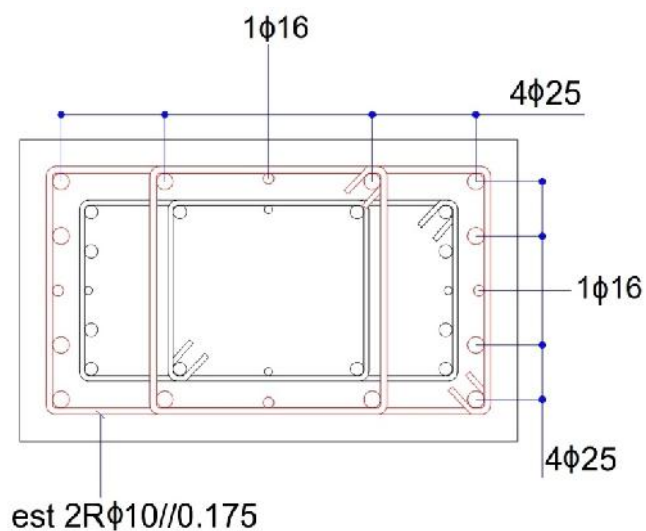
Pormenorização da secção encamisada do pilar B1 do piso 0
